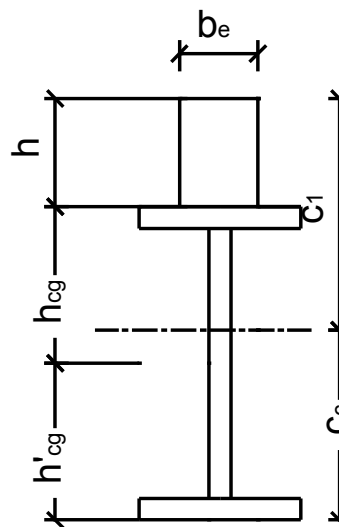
Sección compuesta homogeneizada. Losa de hormigón armado. Eje neutro en la viga.
